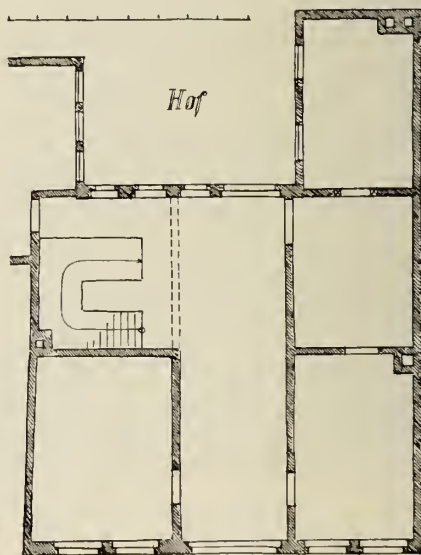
Hannover; Köbelingerstraße 39, Grundriß.
